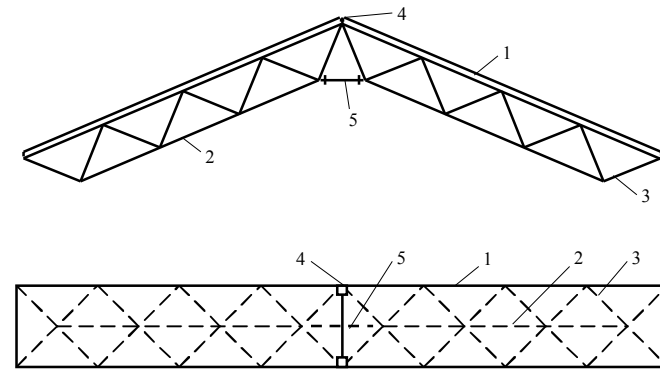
Перекриття з лінійних елементів із двома ухилами: 1 – залізобетонна плита; 2 – нижній пояс структури; 3 – розкоси; 4 – закладні деталі для з'єднання плит; 5 – додатковий стрижень для з'єднання нижнього пояса
